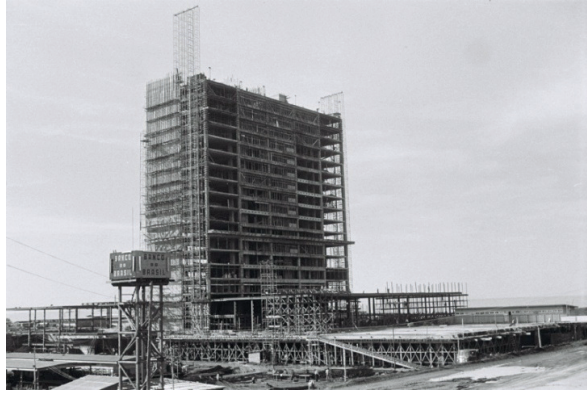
Esquema estrutural da torre do Sede I - pilares ligeiramente recuados da fachada para a colocação da esquadria corrida e empenas laterais de contraventamento. Foto: Ivo Penna, 1959.
